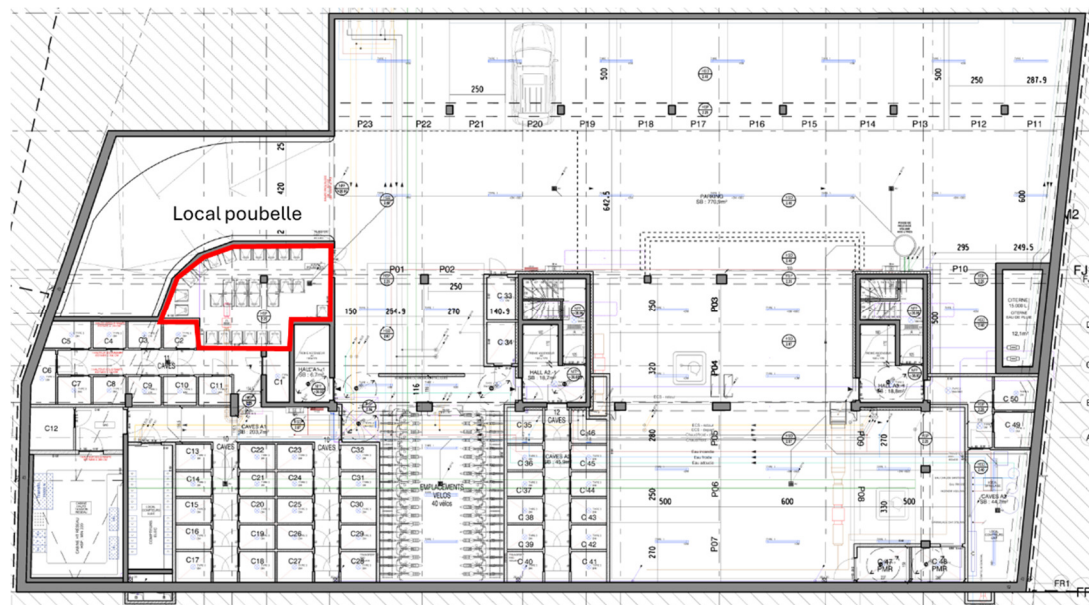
Plan du sous-sol avec emplacement du local poubelles (source: [référence]).
